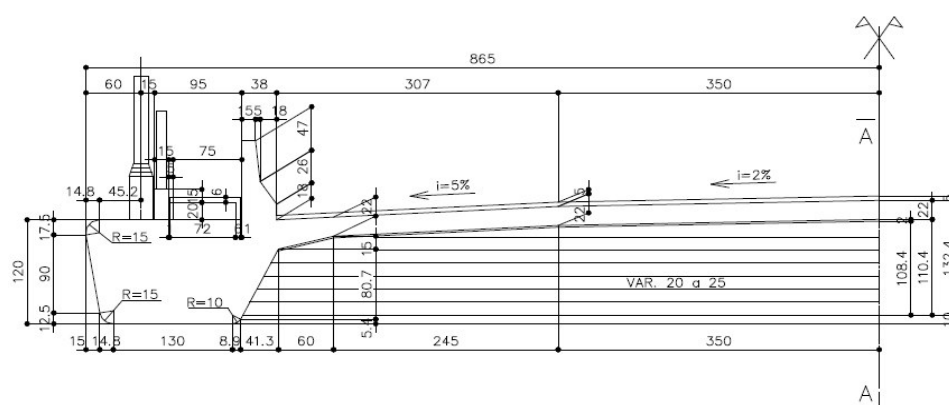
medidas da meia seção transversal tipo da ponte – simétrica
